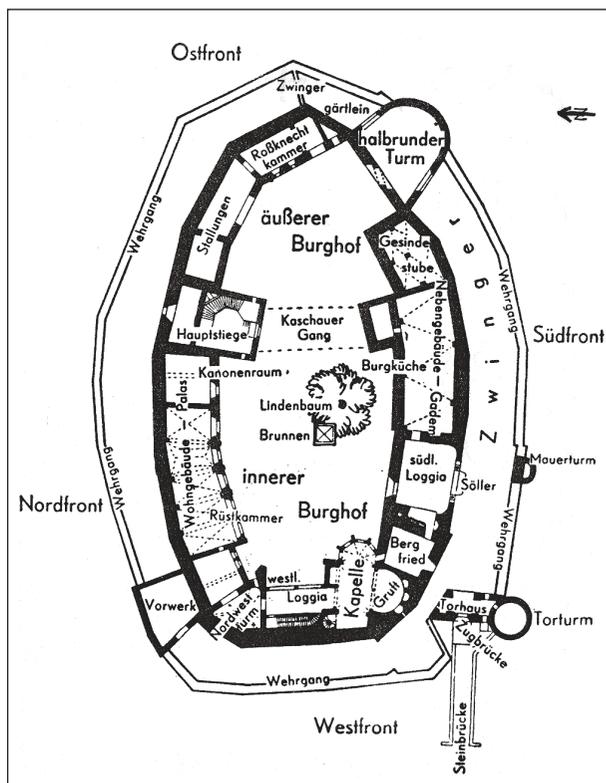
Burg Kreuzenstein in Niederösterreich. Grundriss der rekonstruierten Burganlage (Foto: Verf.).
